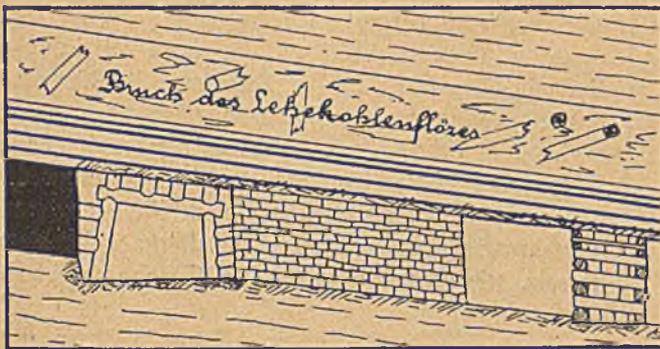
Zimmerung vor dem Einbau der Schlammantel.
